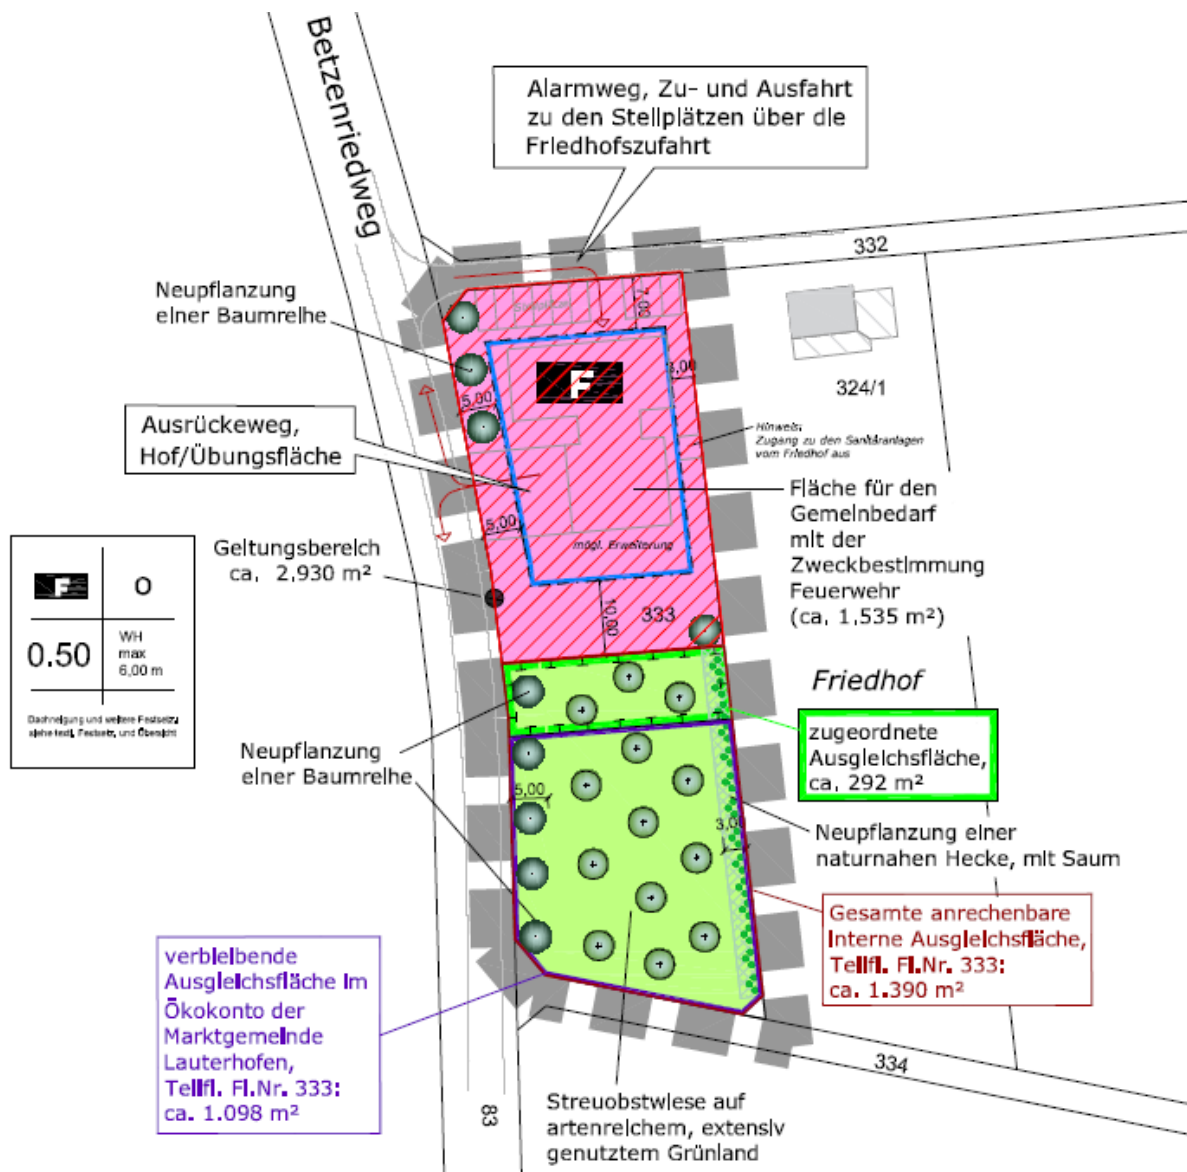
Eingriffsfläche (rot schraffierte Flächen)
